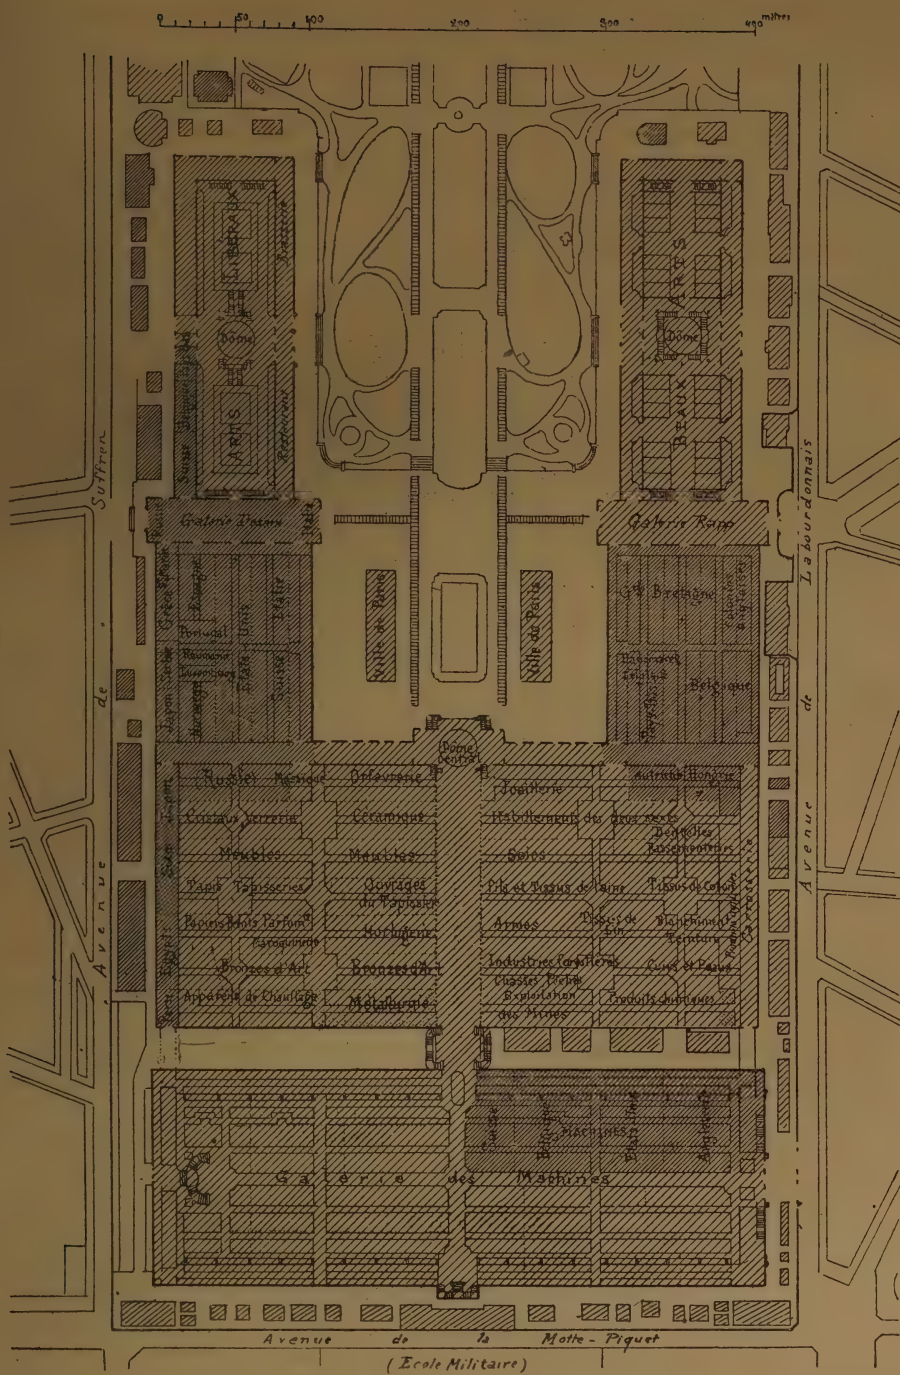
Plan des palais du Champ-de-Mars, en 1889.
